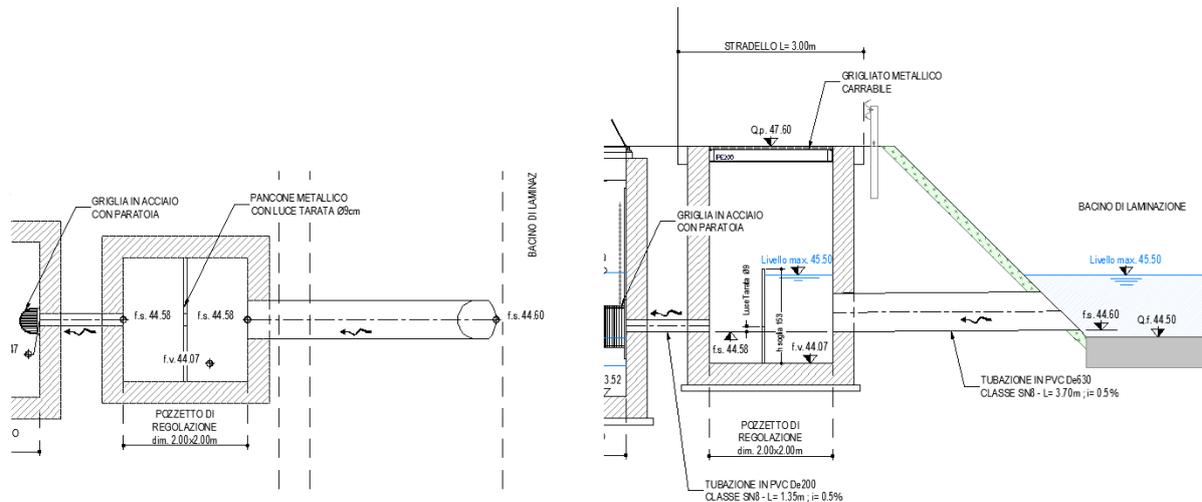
Pianta e sezione del pozzetto di regolazione a valle del bacino di laminazione
